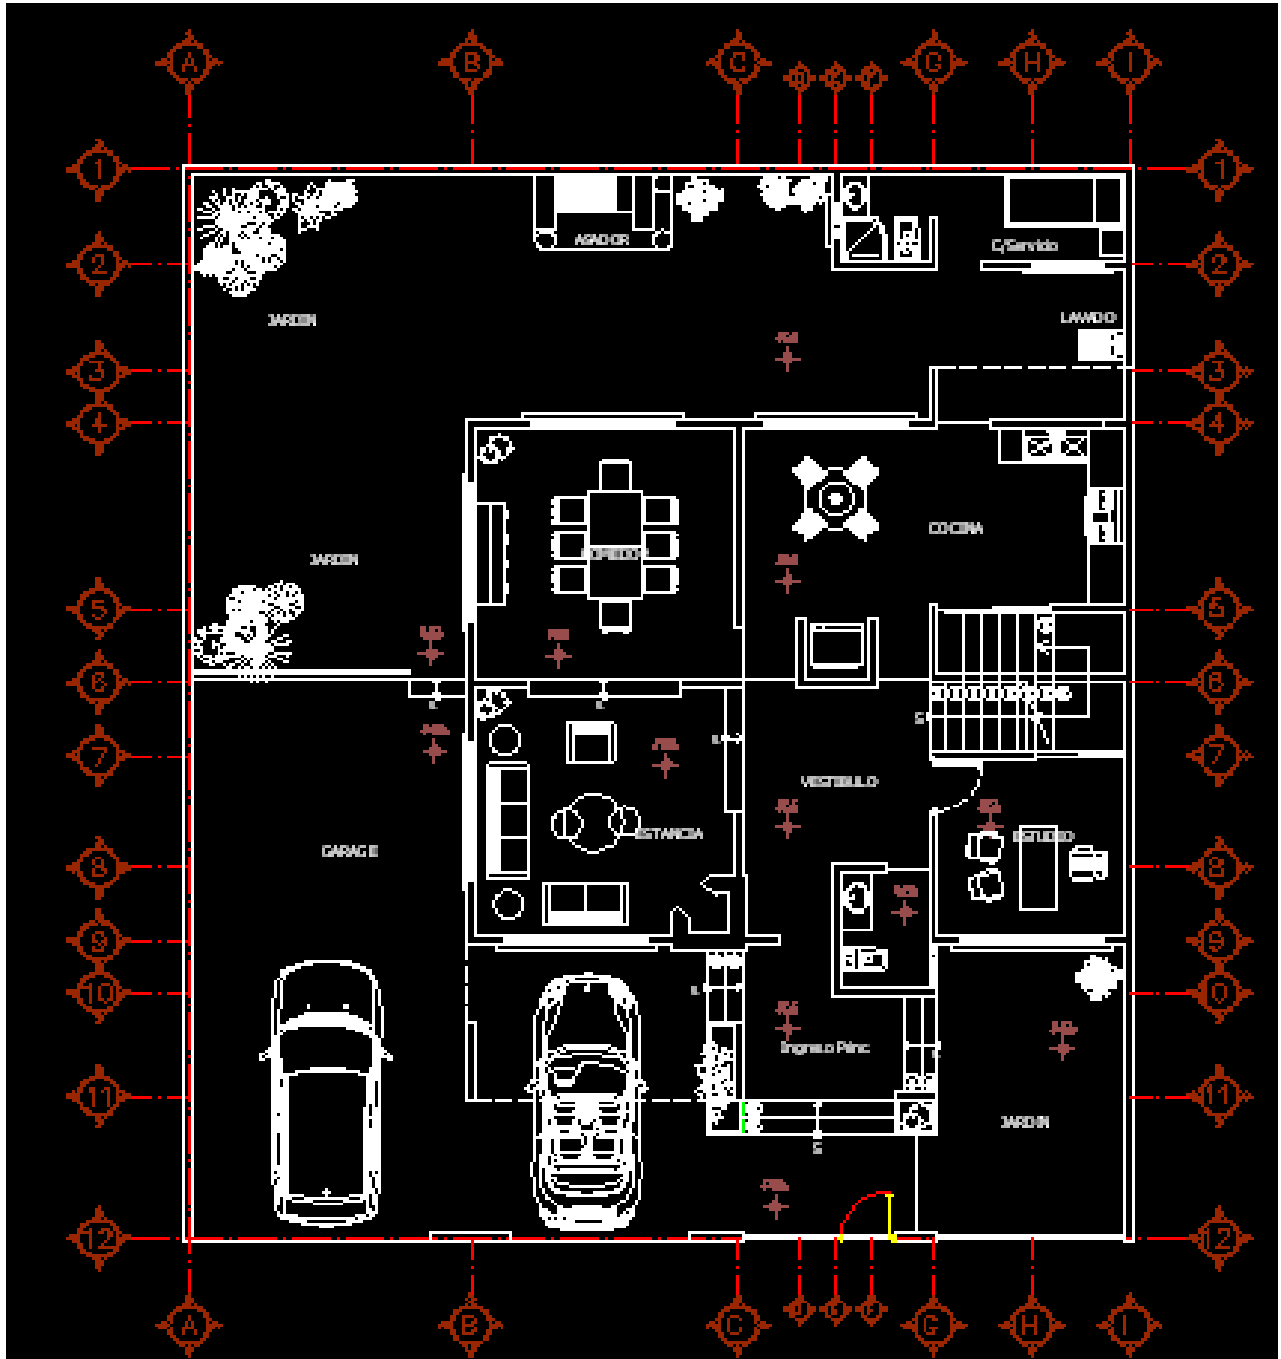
a) Plano de la casa a digitalizar: planta baja
